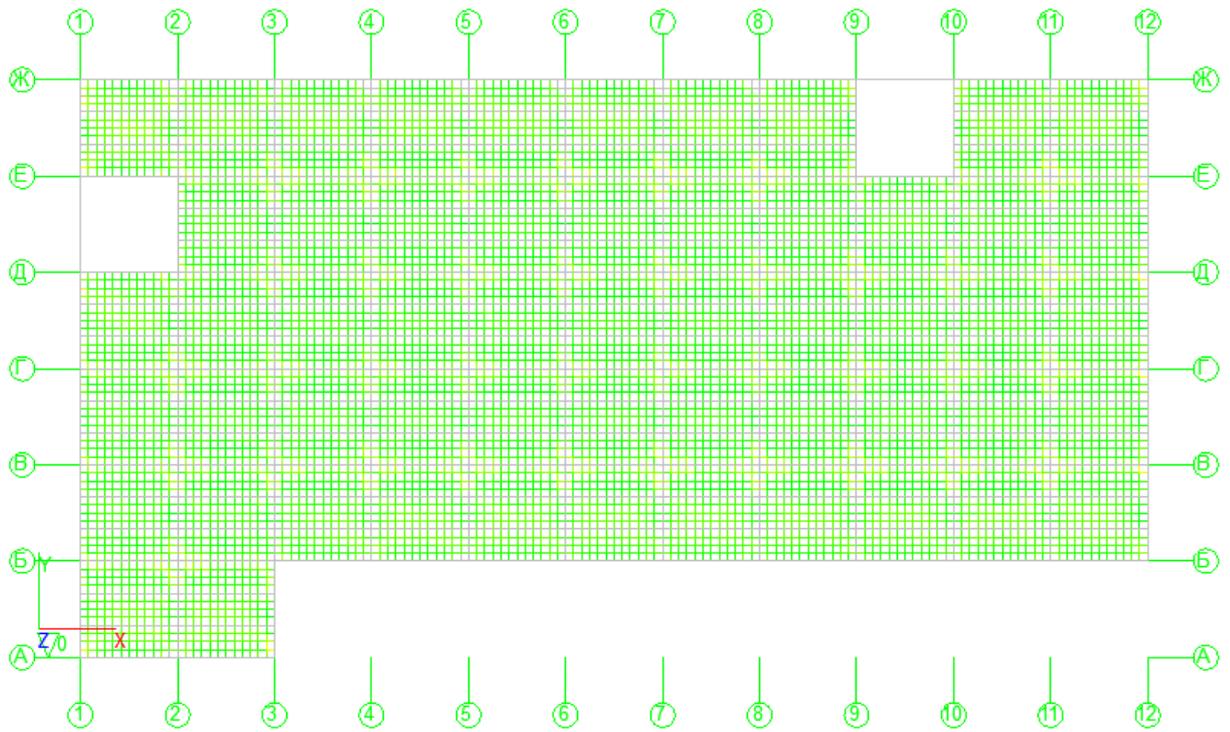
Интенсивность армирования нижнего пояса плиты перекрытия по ОХ
